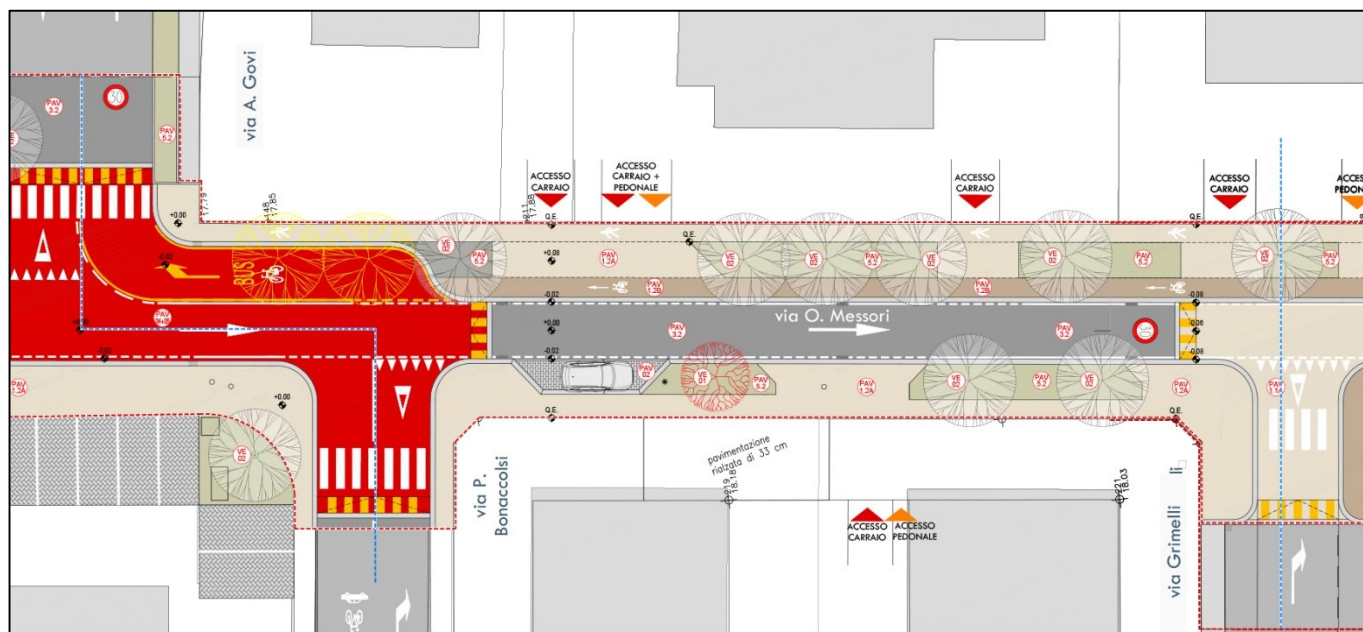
elaborato di progetto - stralcio d'intervento n°2
